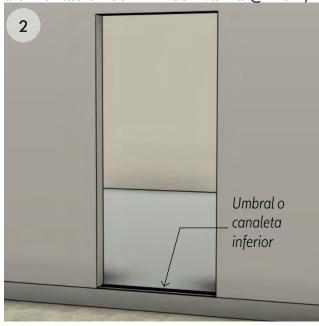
Paso 2. Se coloca la canaleta inferior en el umbral de puerta con 4 tornillos de 3 1/2". Elaboración propia.
